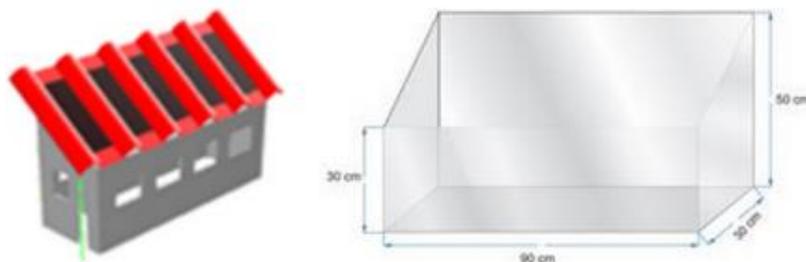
Planta da casa realizada com *AutoCad* e dimensões da estrutura do protótipo
